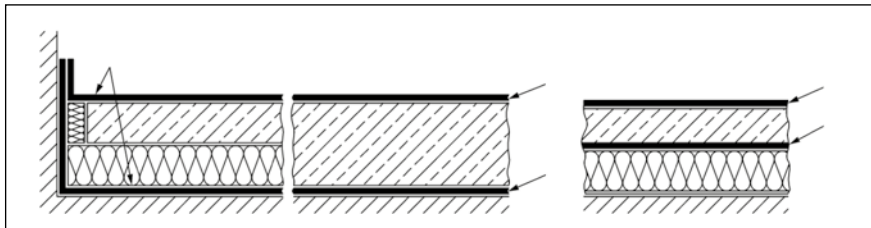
■ Bauweise mit Abdichtungsschicht unterhalb und oberhalb eines Estrichs (DIN 18534 [1])
